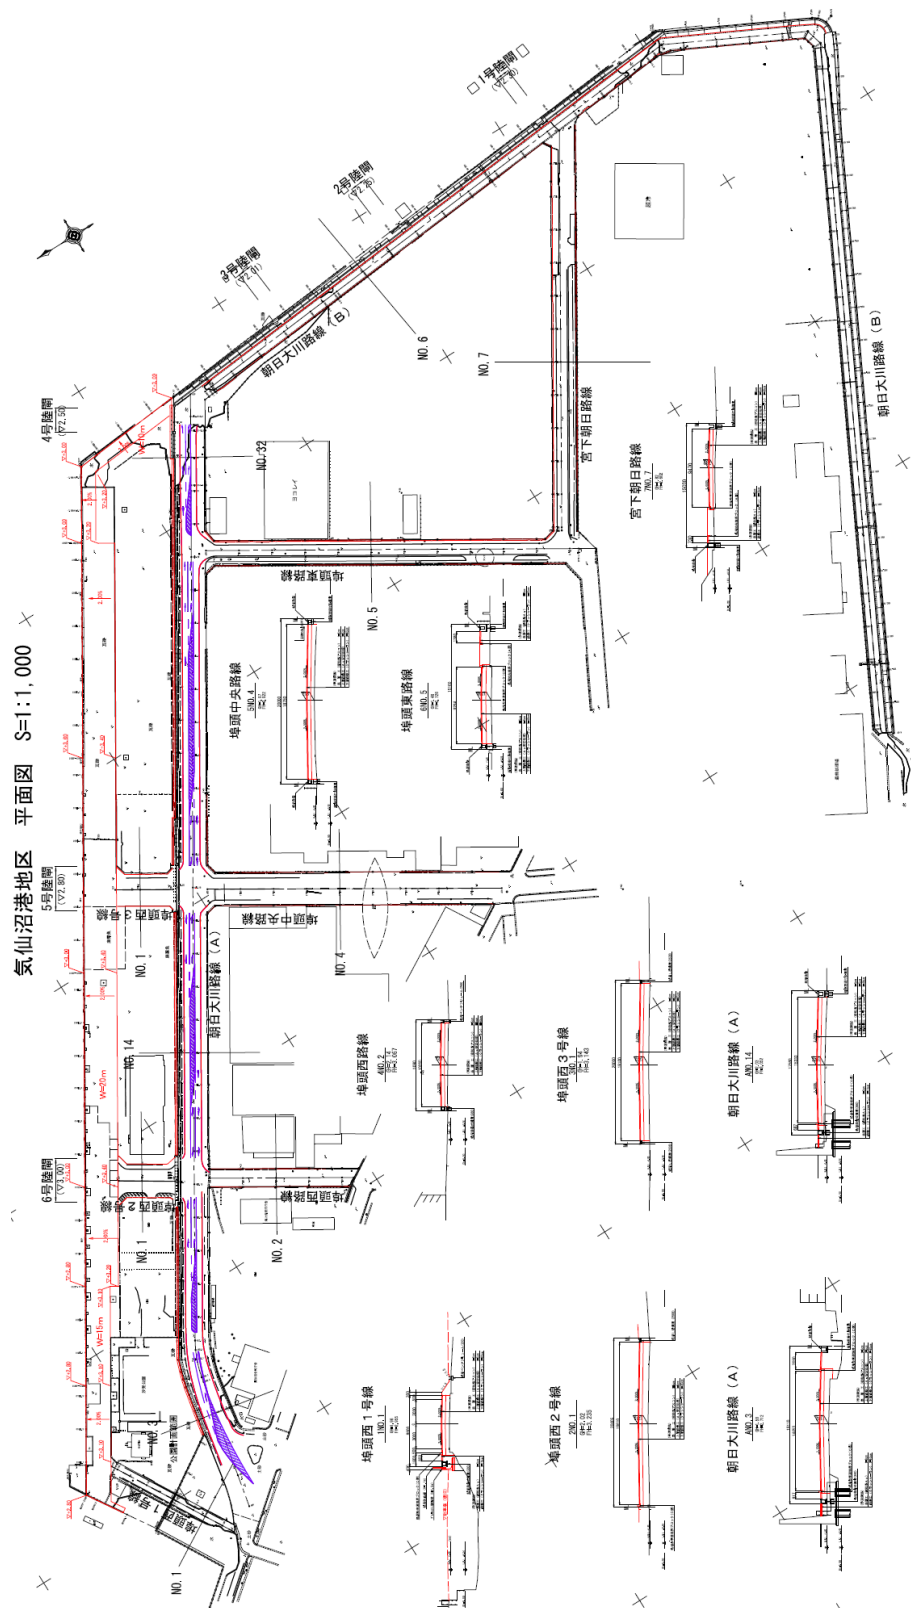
No.4 埠頭西3号線平面図(復旧後)
